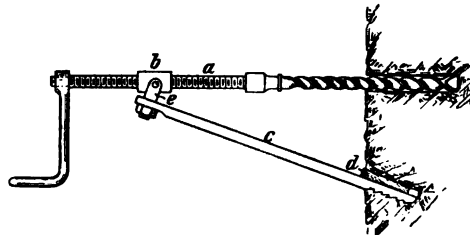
Maschinenhalter mit Handbohrmaschine.
